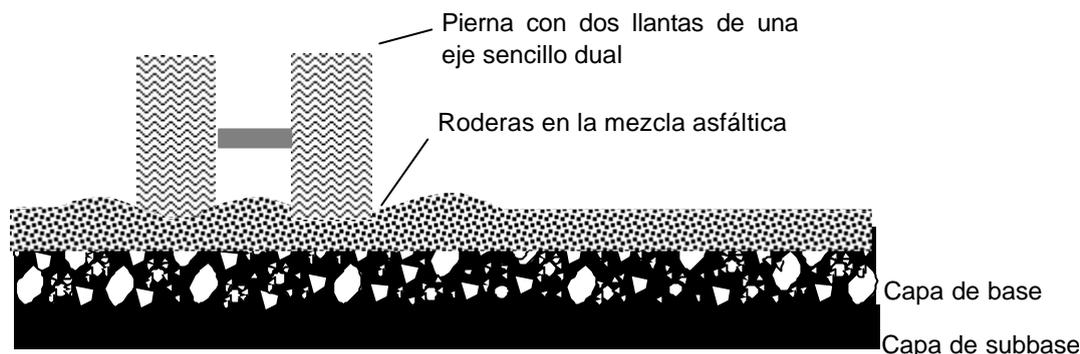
Esquema de la estructura de un pavimento flexible con roderas en la mezcla asfáltica.
